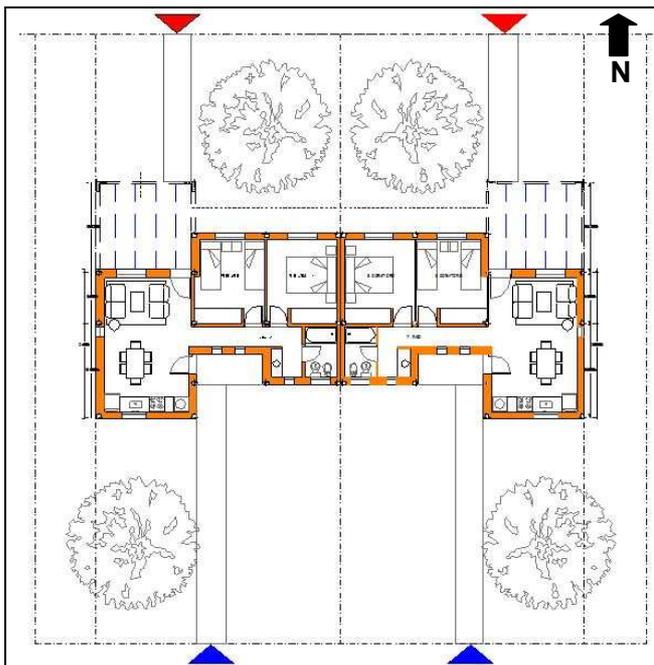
Plantas de la vivienda con acceso Norte o Sur
